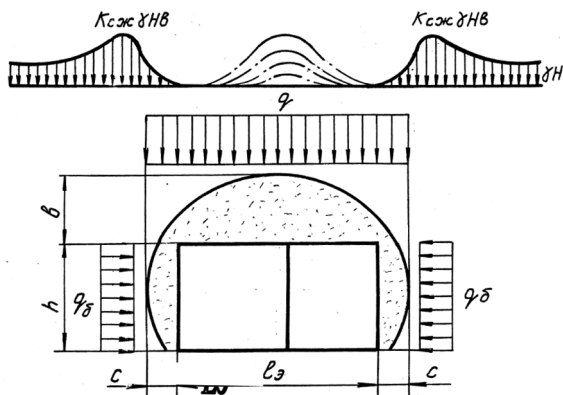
Расчетная схема к определению нагрузки на крепь сопряжения
